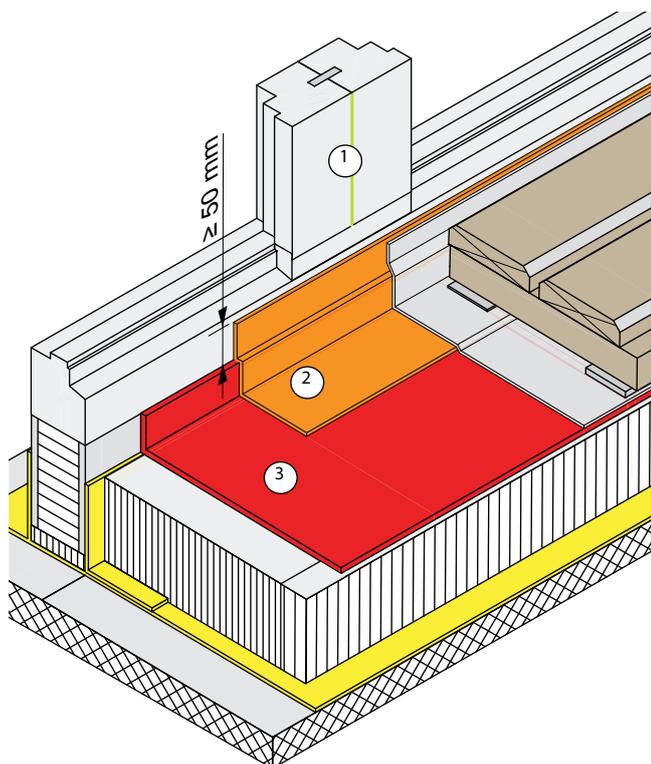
giunto tra elementi a collegamento fisso meccanico e impermeabilizzato (1), resina (2), impermeabilizzazione (3)
